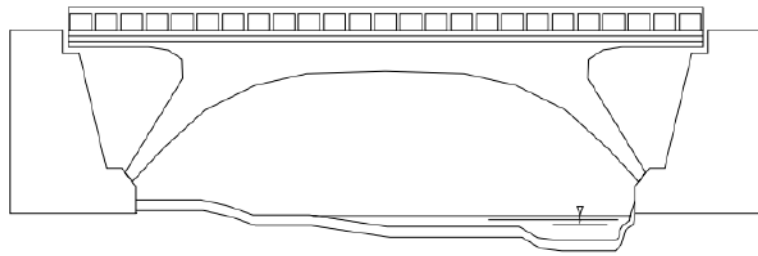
Puente Pórtico tipo jabalconados Perfil Longitudinal.
